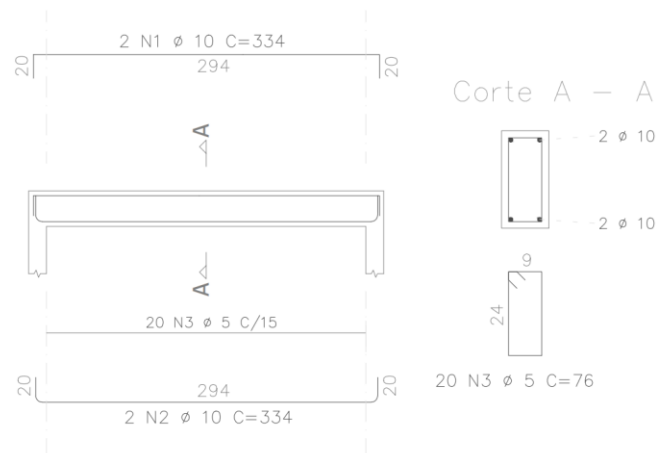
Detalhamento de todas as vigas e vigas baldrames de 3 m.
